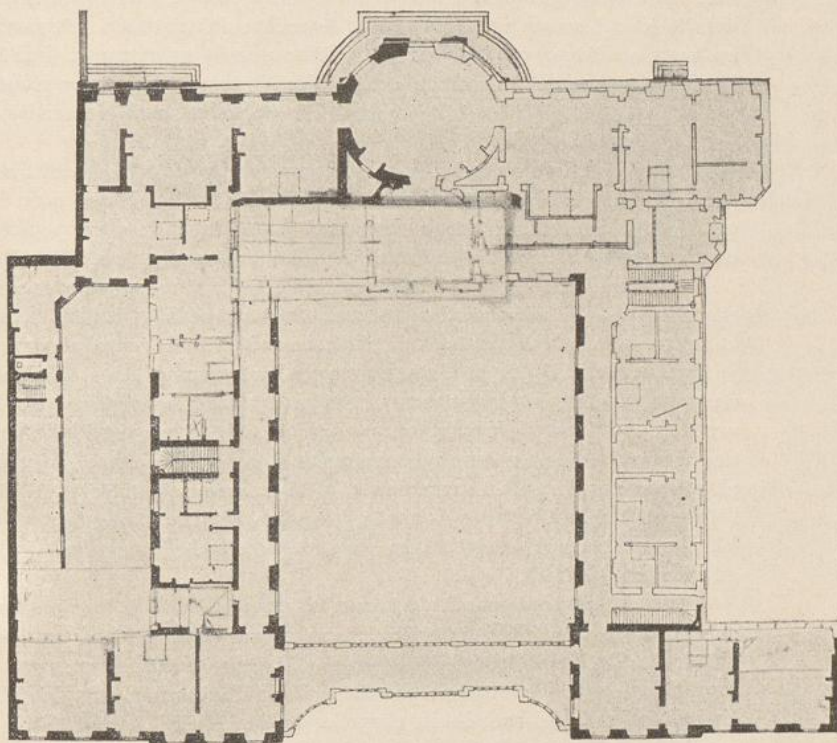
Palais Thurn und Taxis; Skizze de Cottes zum Grundriss des I. Obergeschosses.
